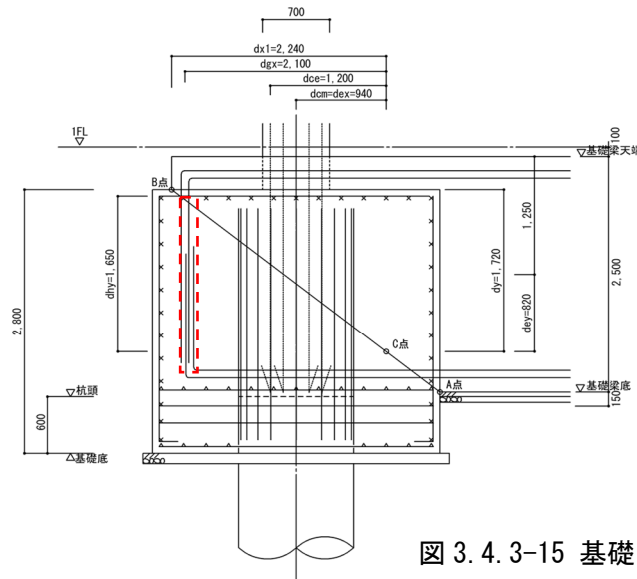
基礎・基礎梁配筋と破壊面
